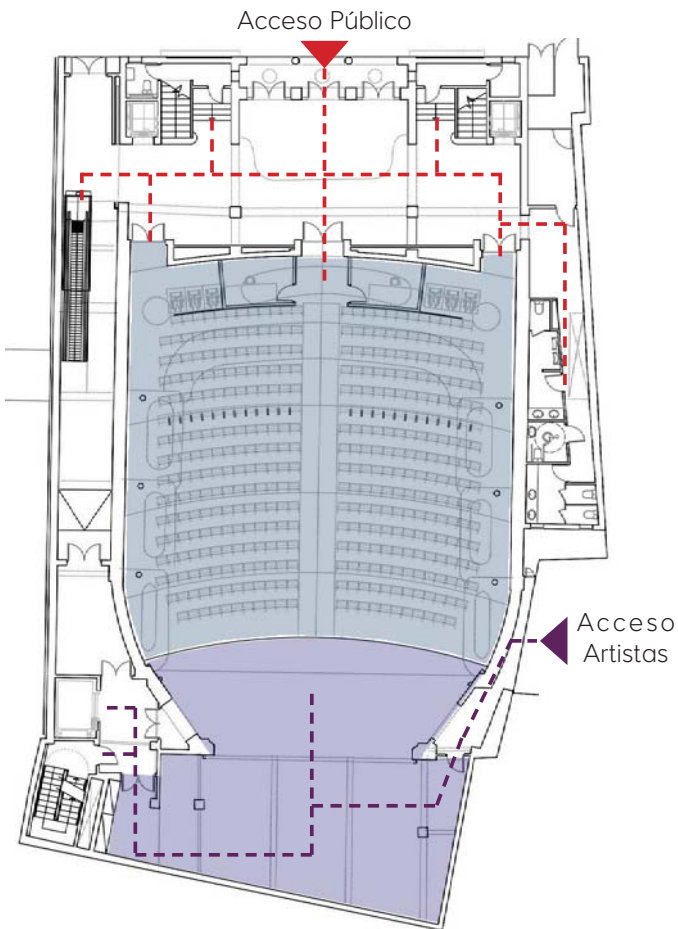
Planta Baja Teatro Góngora de Córdoba
